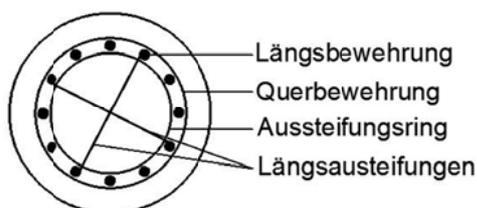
Schema für den Bewehrungseinbau im Querschnitt
